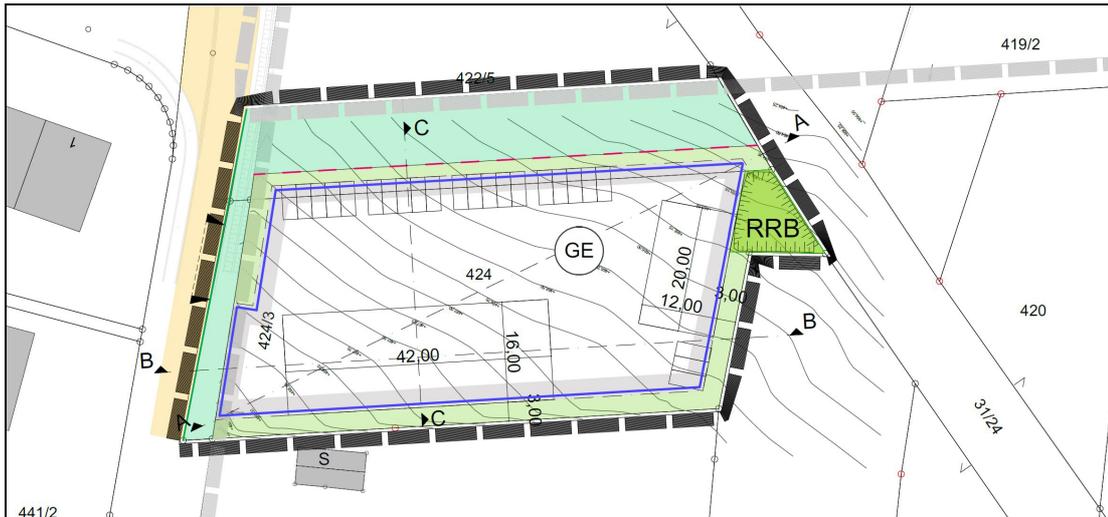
Lageplan des Bebauungsplans "GE Kitzberger Feld Ost"
